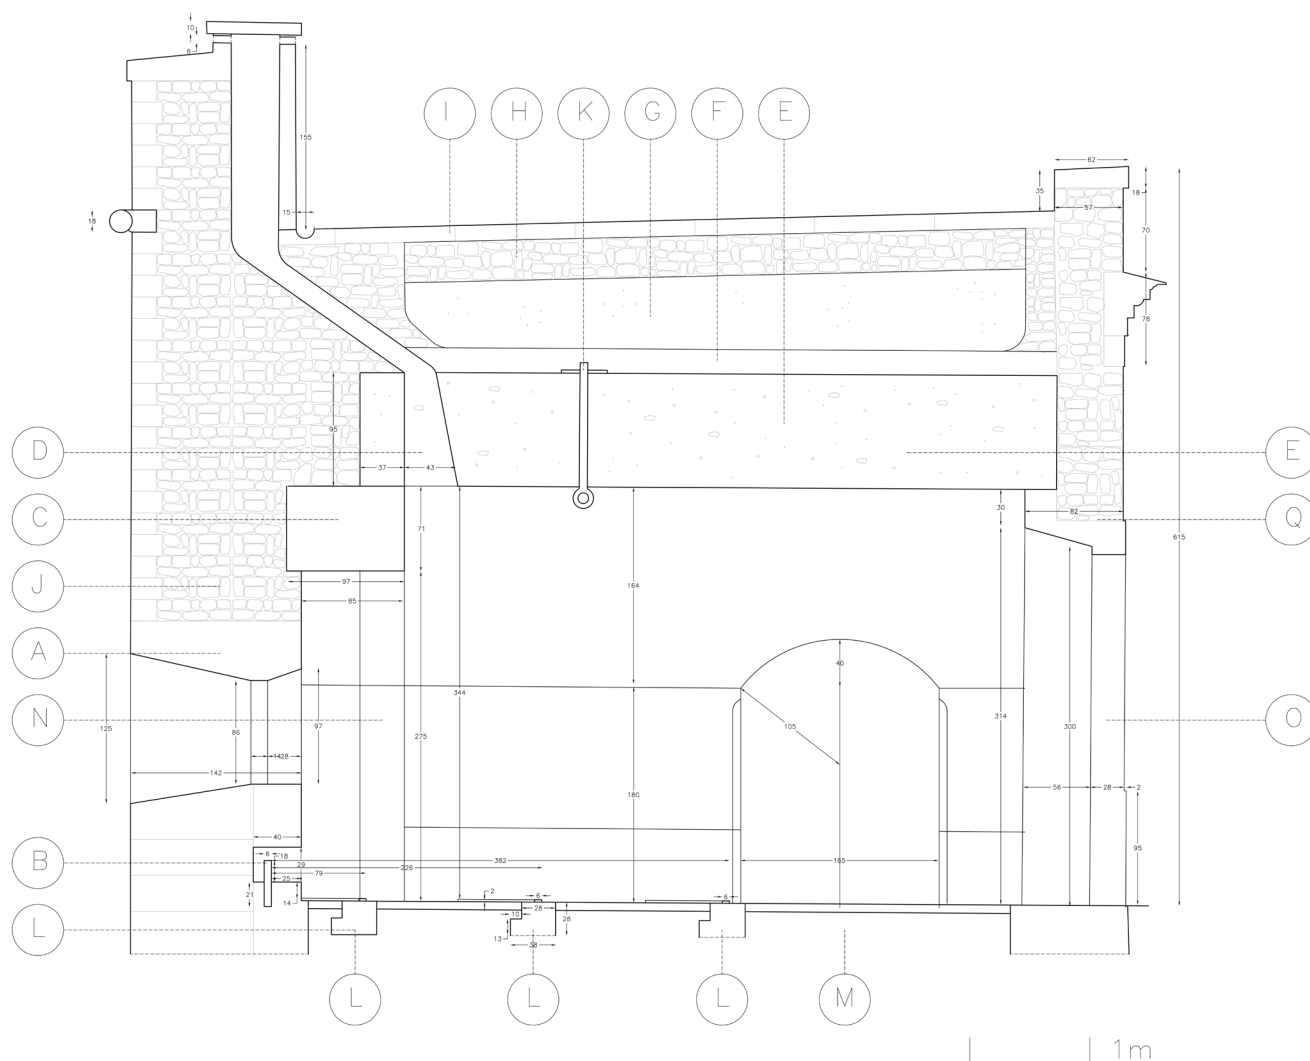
Sección constructiva de casamata tipo A a partir del proyecto para el baluarte de la Candelaria (Cádiz) (Dibujo de los autores). A.-Cañonera de sillera. B.-Perno pintado. C.-Espesor del arco de penetración formado con hormigón hidráulico. D.-Chimenea de ventilación. E.-Espesor de la bóveda de hormigón hidráulico. F.-Espesor del plano inclinado de hormigón hidráulico. G.-Relleno de tierra apisonada. H.-Macizo de la explanada ejecutado con mampostería medianamente hidráulica. I.-Explanada de losas. J.-Muro de máscara de la batería ejecutado con mampostería ordinaria y revestimiento exterior de sillarejo. K.-Anclaje y cáncamo para suspensión de batería. L.-Curvas de madera con llantas de hierro para guía de la artillería. M.-Comunicación entre casamatas. N.-Arranque del arco de penetración y bóveda. O.-Puerta de entrada. P.-Muro interior
